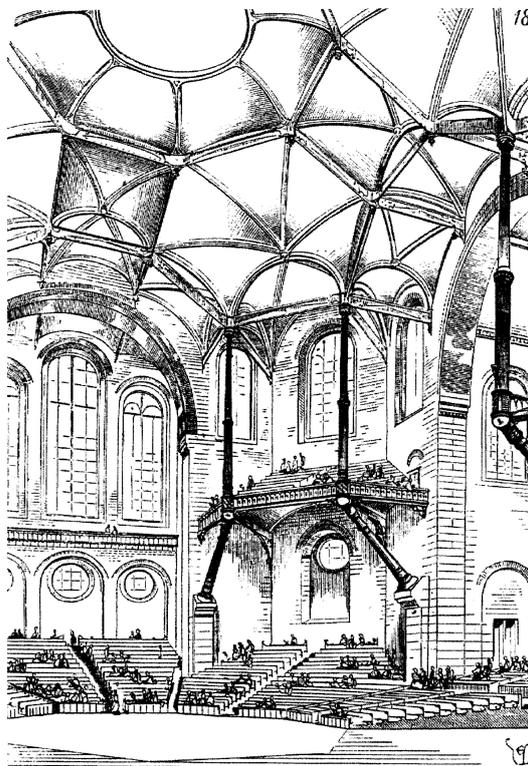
Projeto conceitual de um salão por Viollet-le-Duc, 1863.
